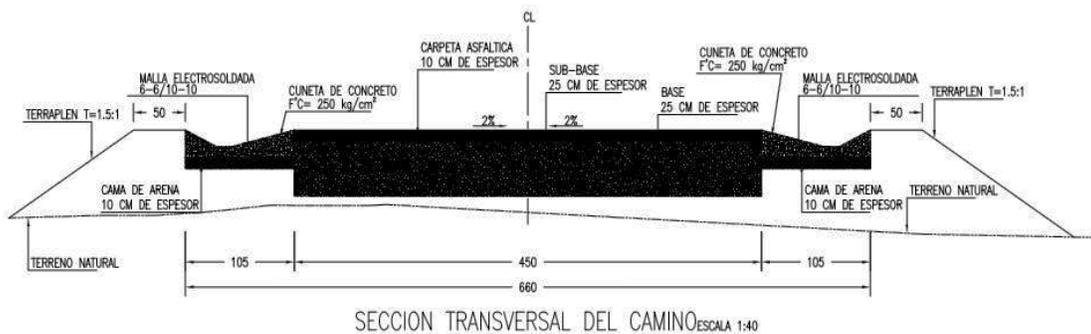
Corte Transversal del Camino de Acceso al Muelle.
